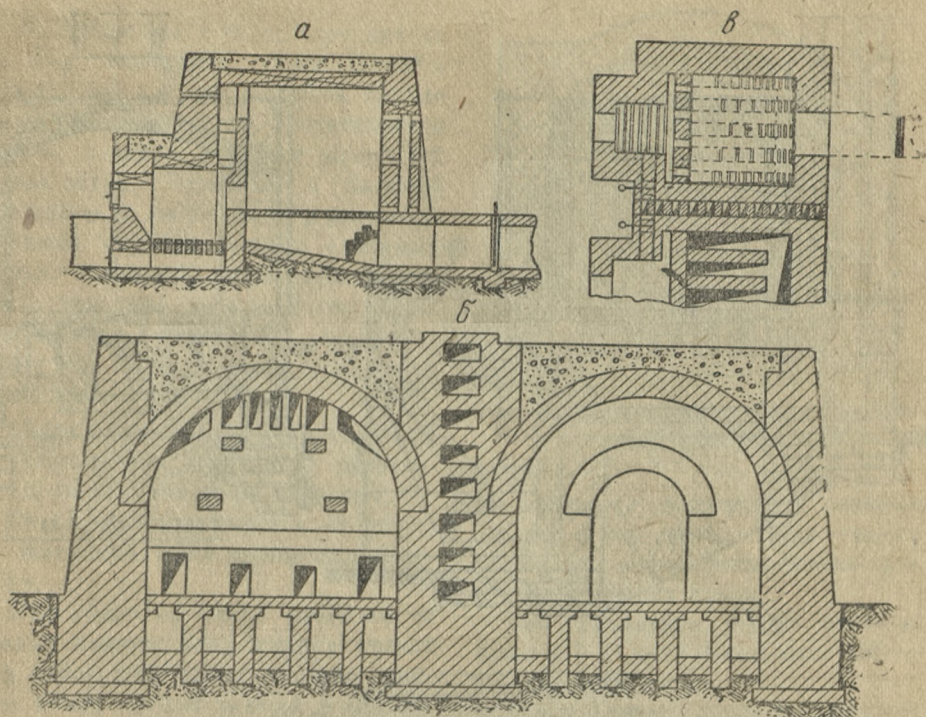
Печь с опрокидным пламенем Росстромпроекта с изменениями А. К. Цедилина: а—продольный разрез, б—поперечный разрез и в—план
